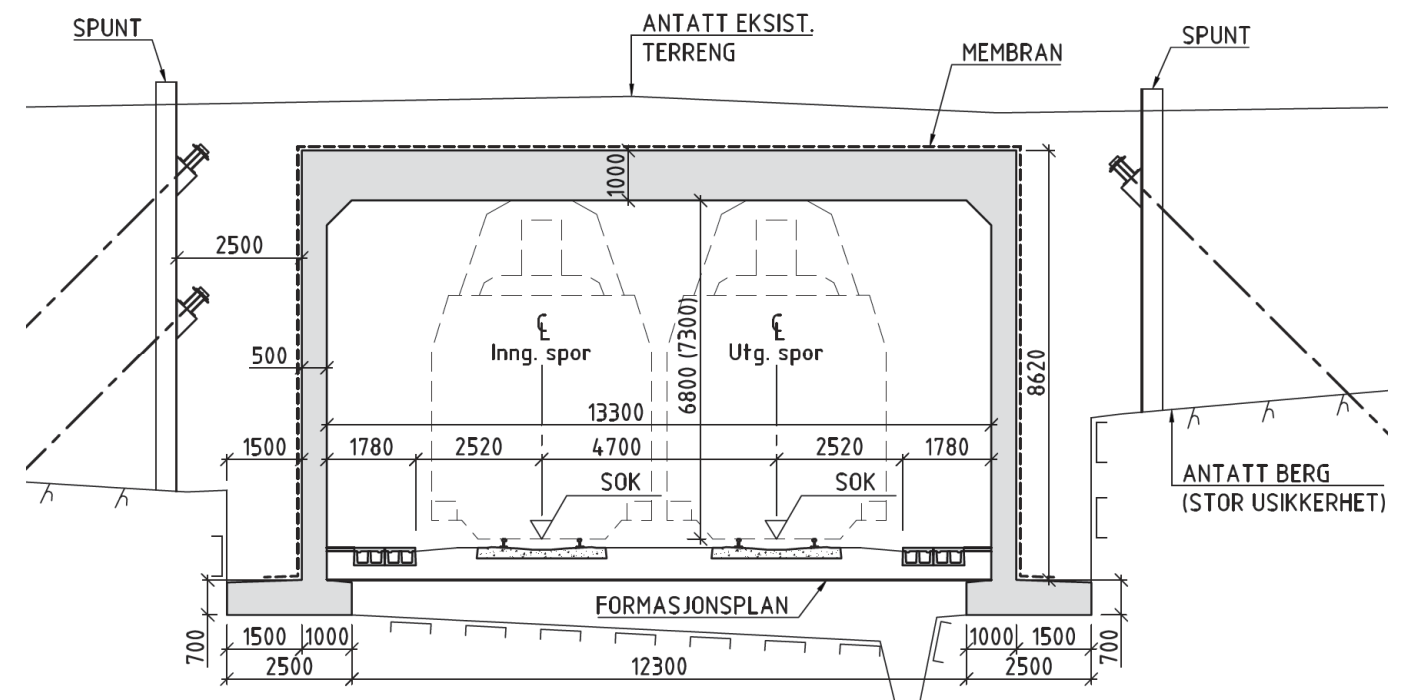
Typisk tverrsnitt for betongtunnel/portalkonstruksjon. Nivå for overfylling/eksisterende terreng varierer.
